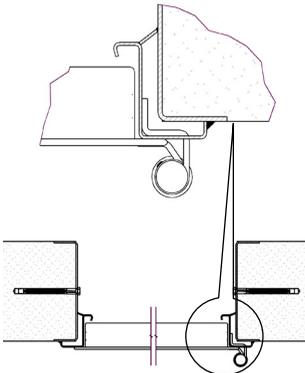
Türelement an Ankerbügel angeschweißt (Porenbetonwand Dübelmontage)
